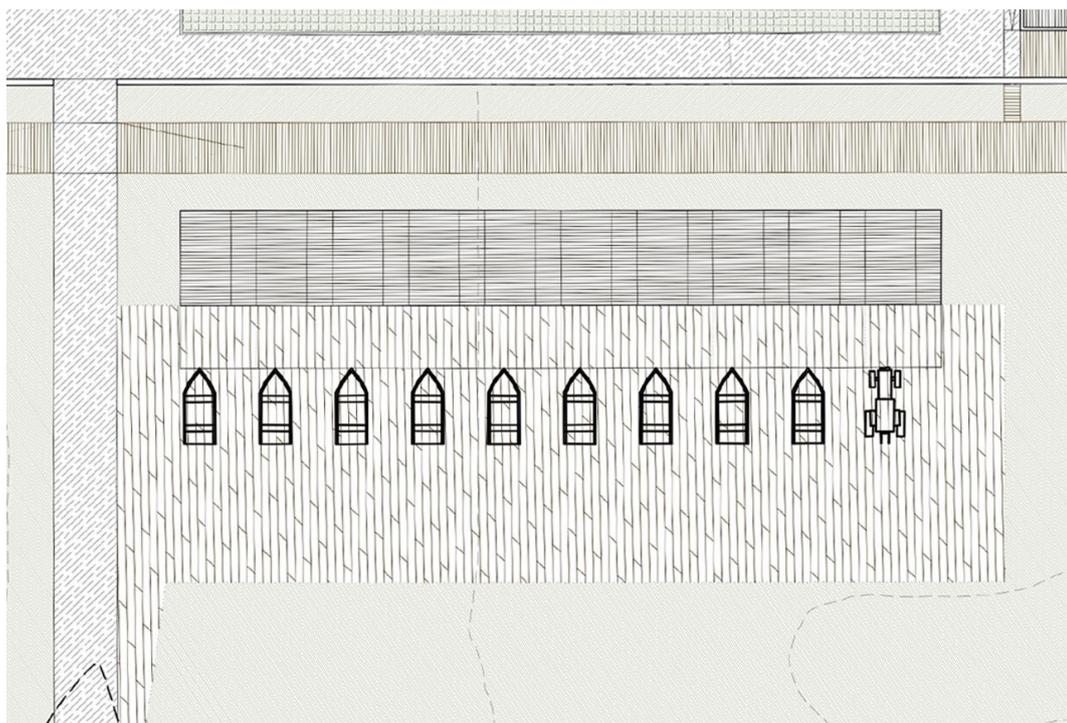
Instalações dos Aprestos dos Pescadores – Implantação – Plano Geral
